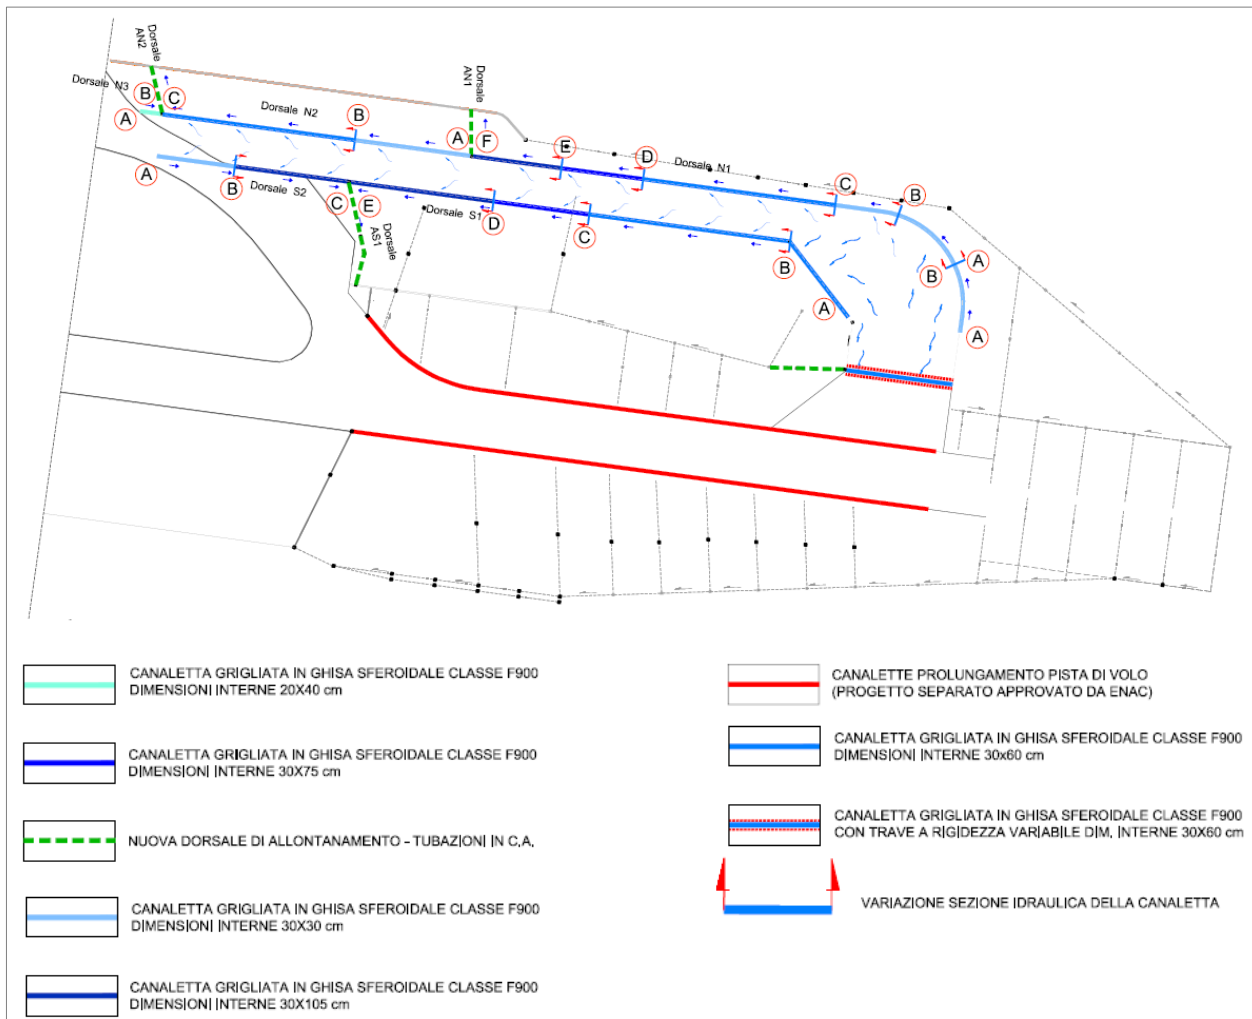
Planimetria idraulica di progetto bretella di collegamento
